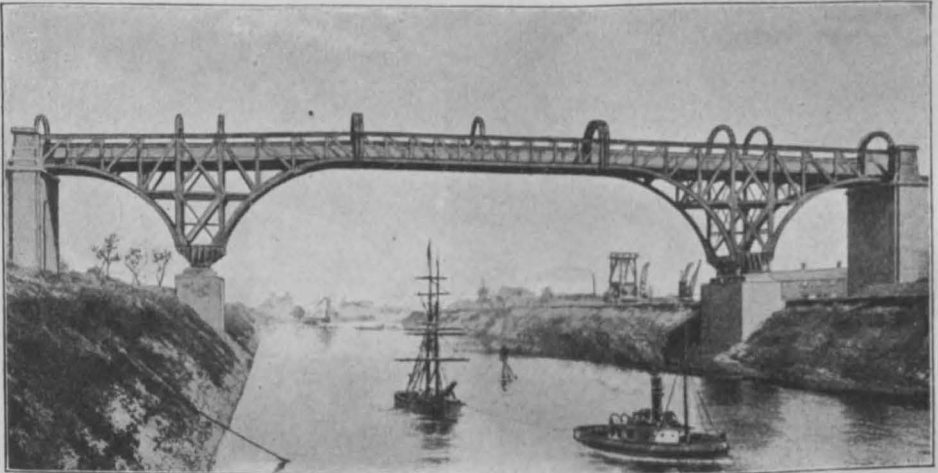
Straßenbrücke bei Warburton in England über den Manchesterkanal.
